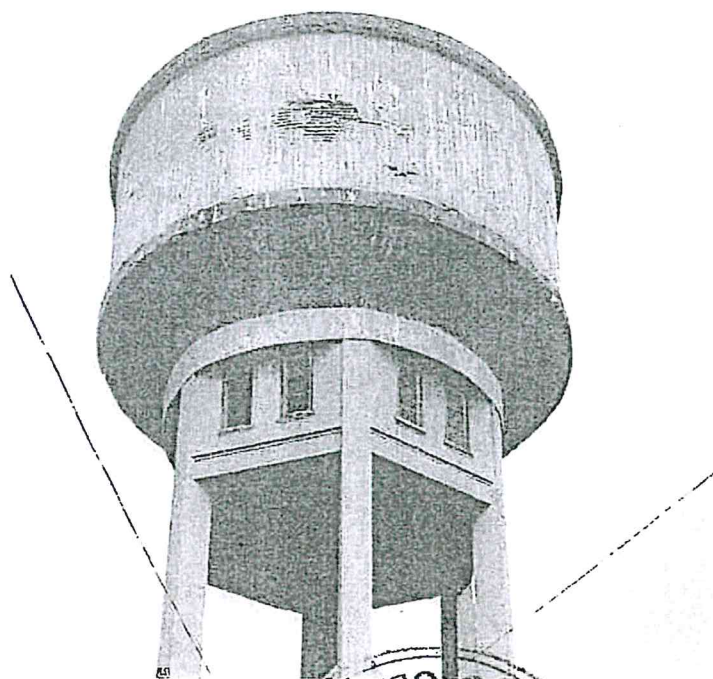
Armături aparente în structura rezervoarului din beton armat
